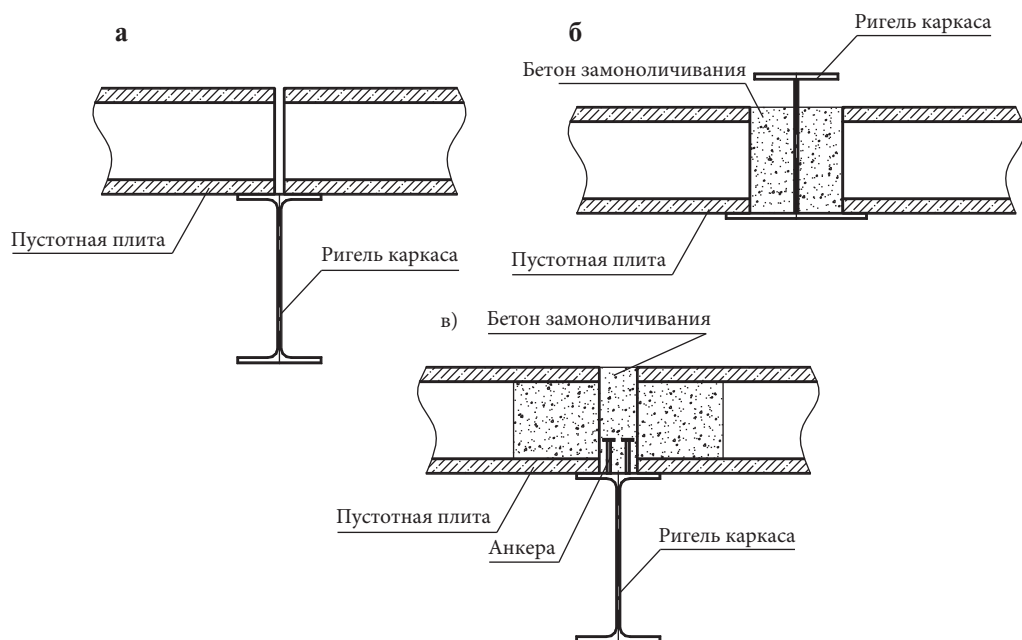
Перекрытия многоэтажных зданий из сборных пустотных железобетонных плит со стальным каркасом при опирании: *а*) на верхнюю полку балок без устройства противосдвиговых связей; *б*) на нижнюю более развитую полку без устройства противосдвиговых связей; *в*) на верхнюю полку с устройством противосдвиговых связей и образованием композитной сталежелезобетонной конструкции
